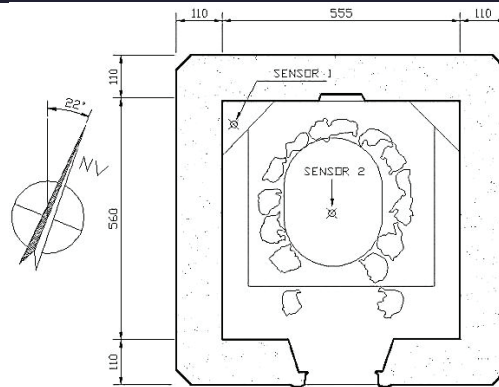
Capela da Ceia – croqui da planta baixa, indicando posição dos sensores.
